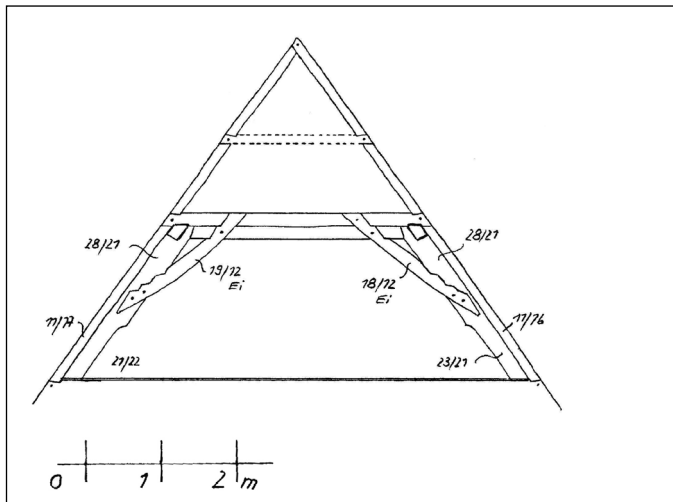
(links): Hauptstraße 34, Querschnitt Dachwerk, Ausschnitt 2. Dachgeschoss.
